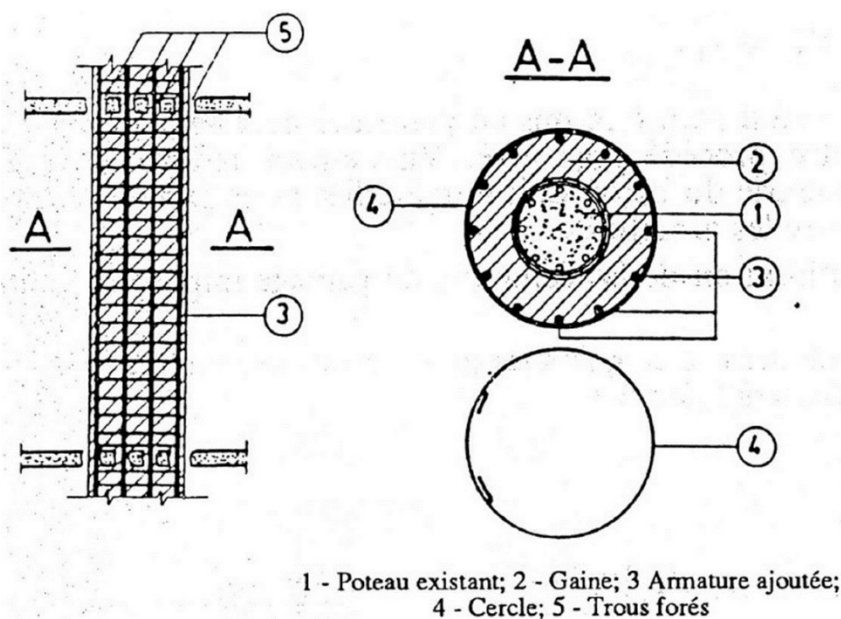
Gainage en béton armé pour poteaux circulaires [3]
